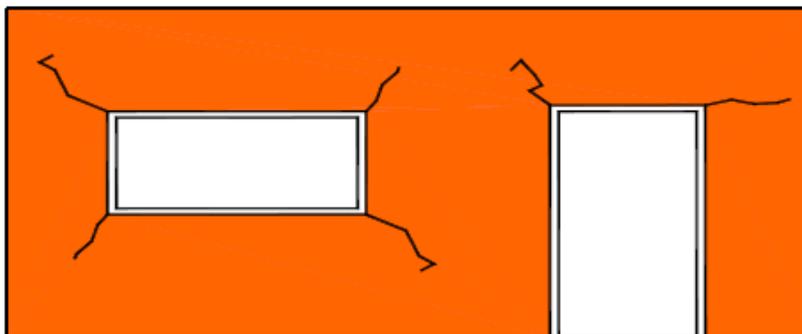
Fissuração típica nos cantos das aberturas, sob atuação excessiva de cargas.
